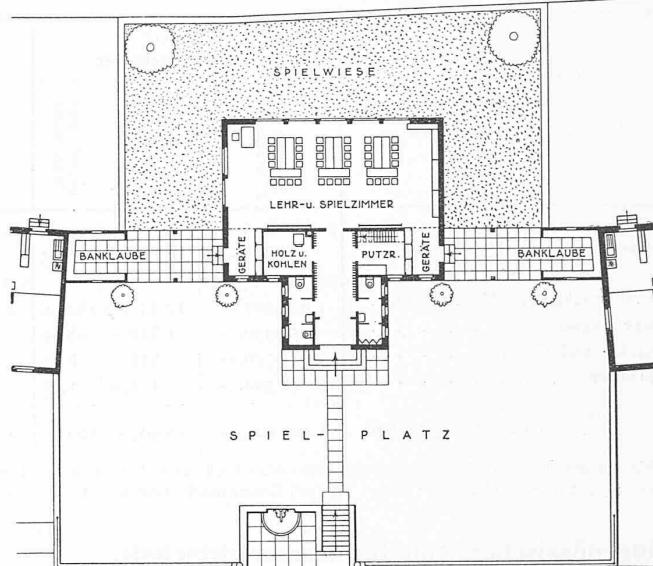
Grundriss des Kindergartenhauses Utohof. — 1 : 400.
